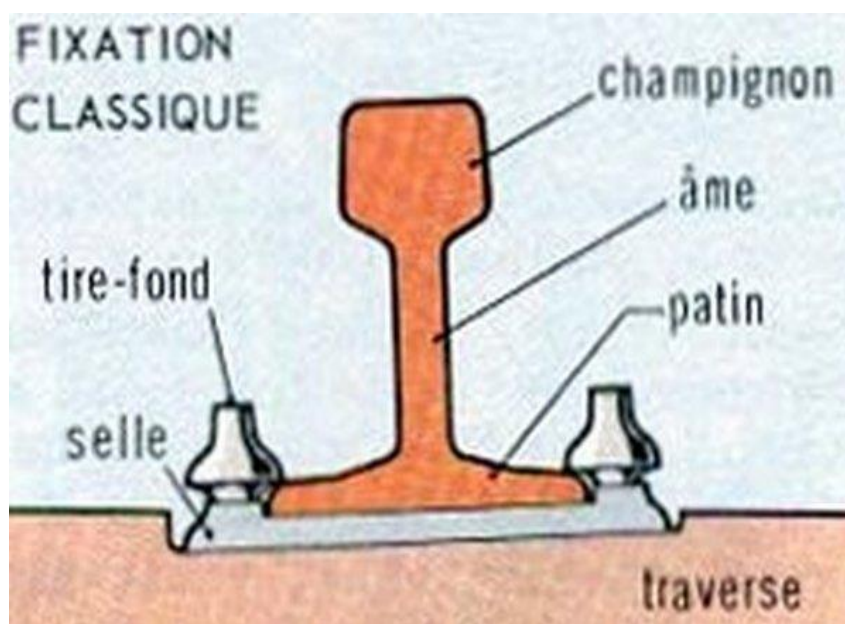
Fixation du rail Vignole sur traverse en bois.
